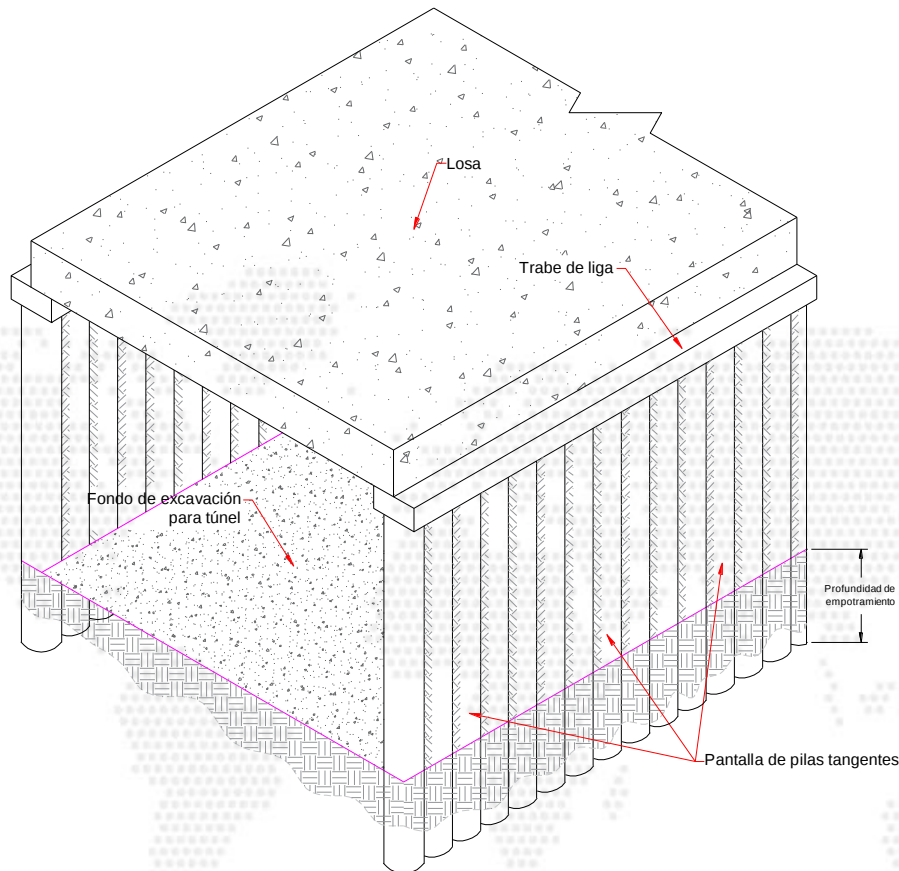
Esquema representativo para la construcción de la pantalla de pilas tangentes (sin escala).
